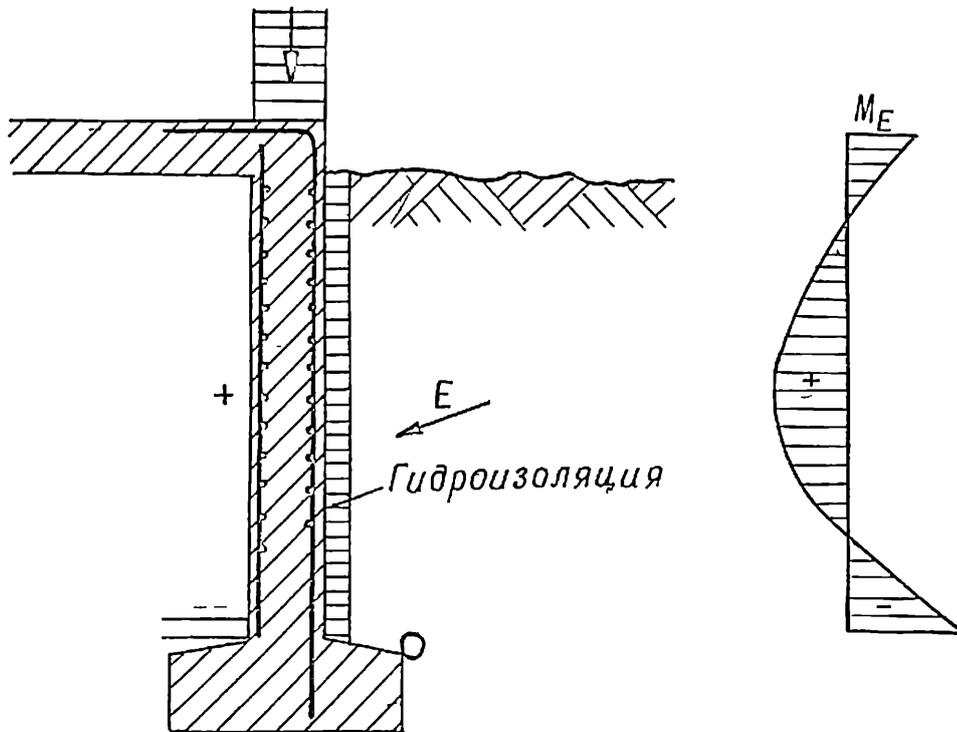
10. Армирование стен подвалов при давлении грунта
